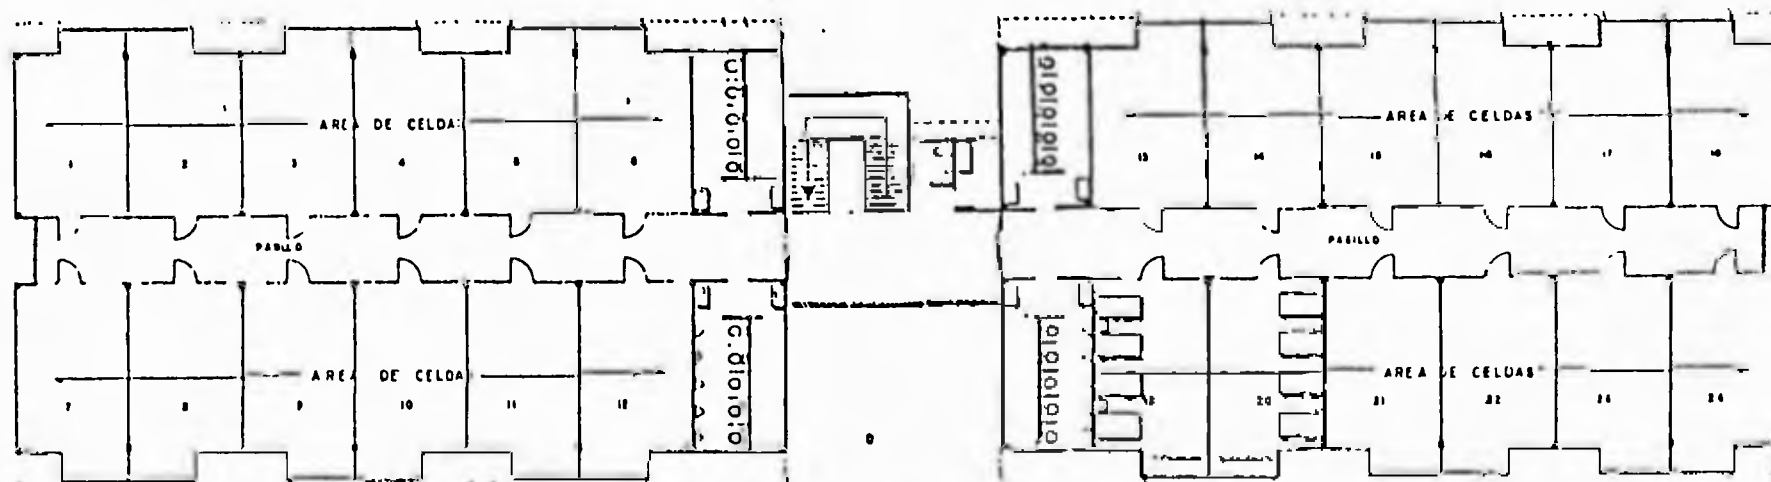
Vista de la planta baja donde se aprecian las galerías y celdas.
